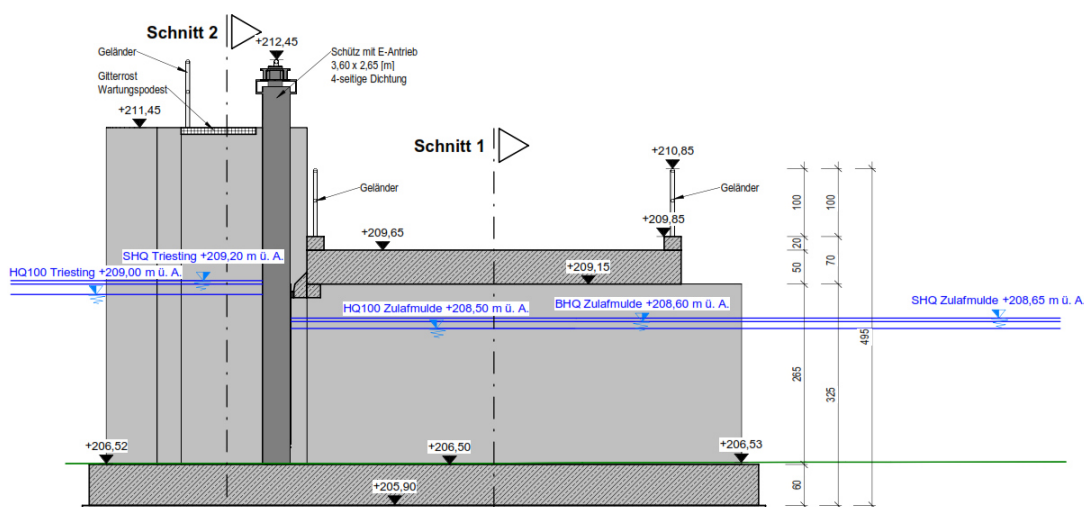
Schnitt durch das Dotationsbauwerk; aus [10]
